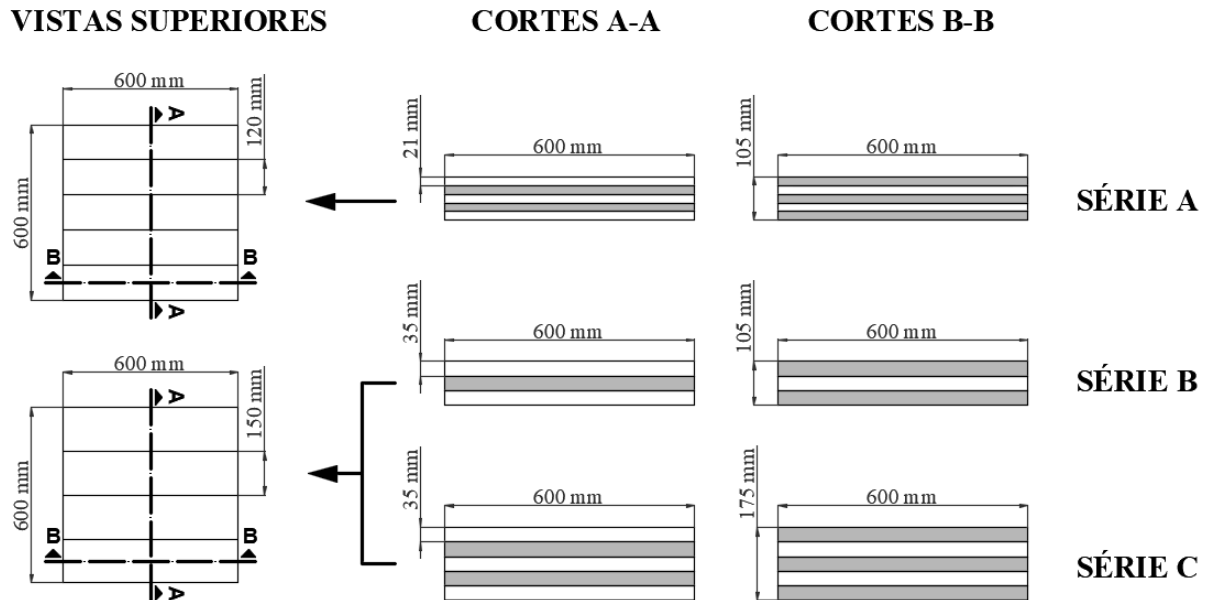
Vista e cortes dos corpos de prova de placas CLT. Camadas longitudinais em branco, transversais em cinza.
